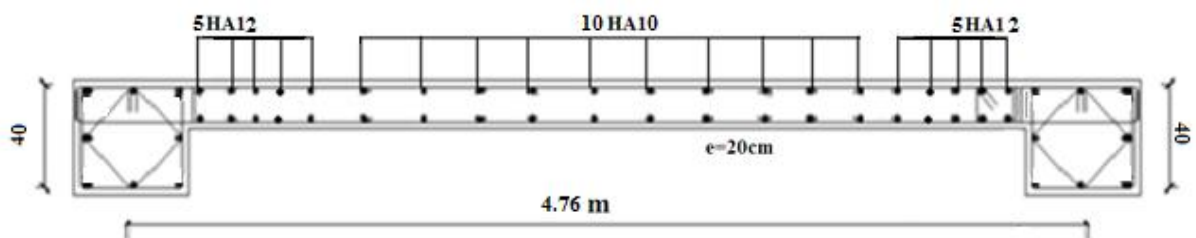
Schéma de ferrailage longitudinal de l'ensemble Poteau (RDC) et voile V1.
